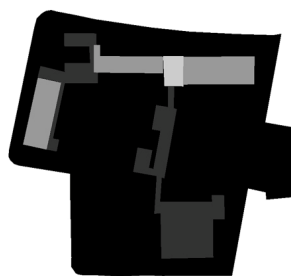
Esquema da planta de implantação da Escola Secundária de Moura, em Moura.
